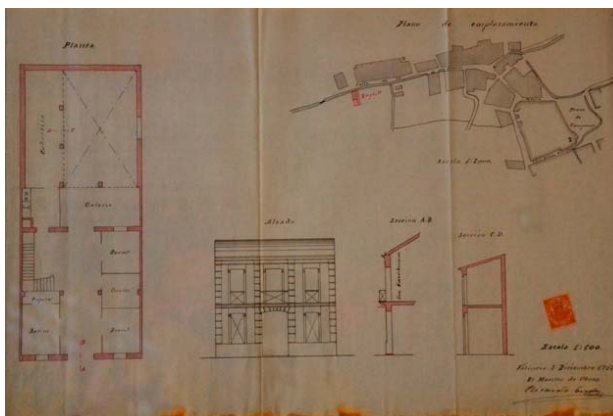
Plano. Licencia para construcción de casa. PU 1917, caja 1, exp. 34.
